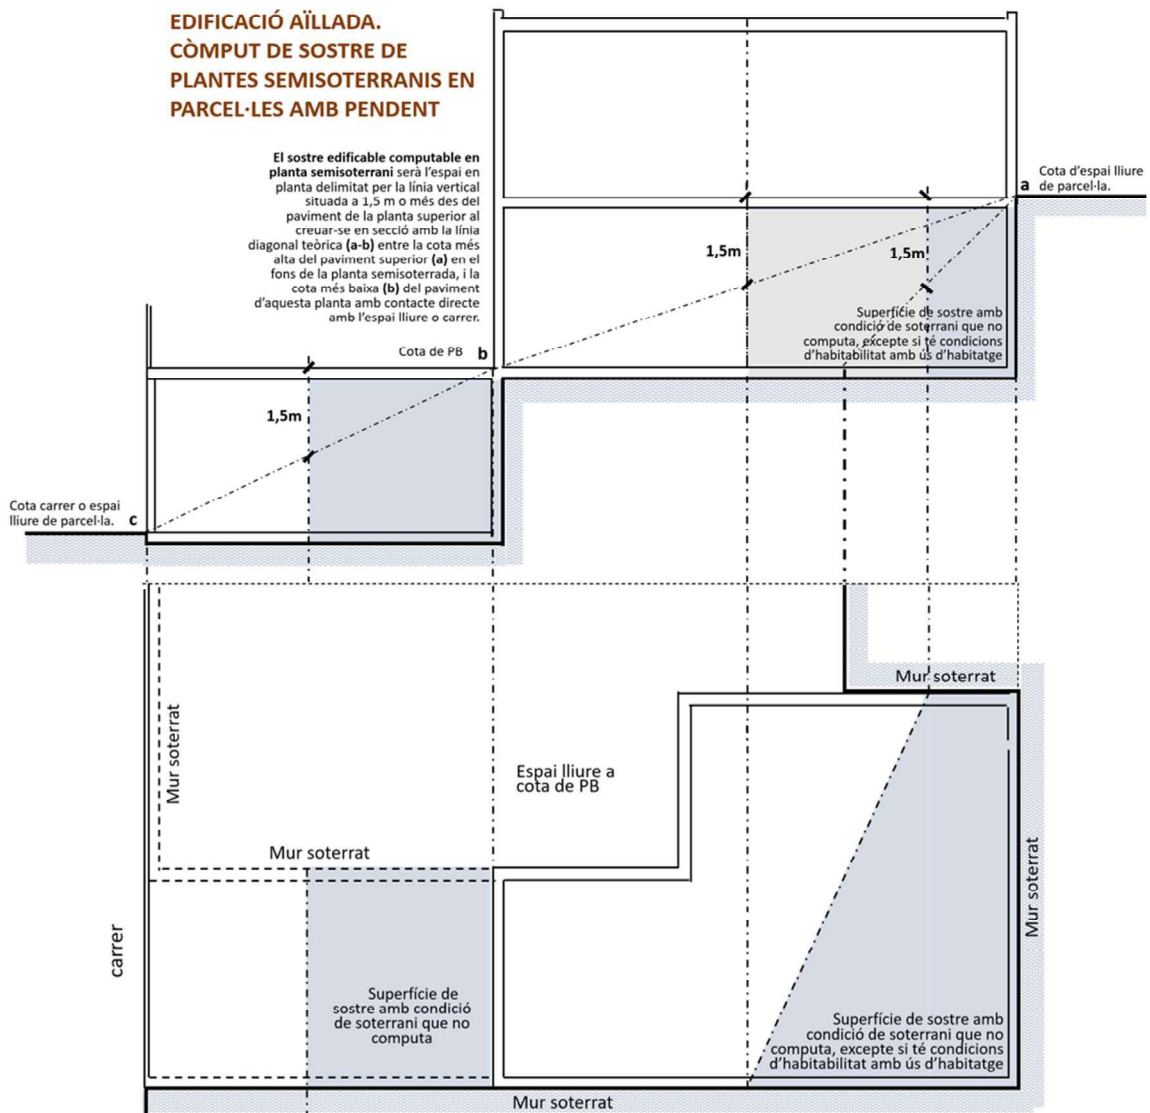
Art. 250.3 i 251.2. Condió de planta baixa i planta soterrani en una planta semi-soterrada als efectes del còmput del nombre màxim de plantes i del còmput del sostre edificable.
